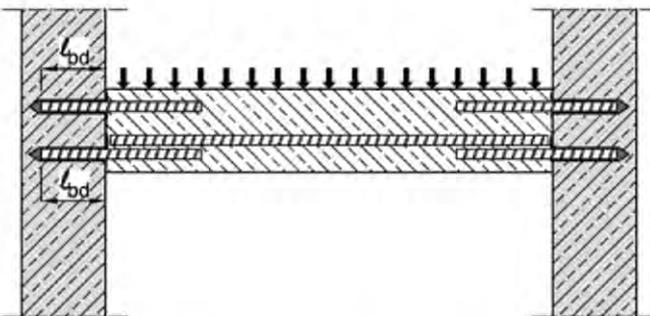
Bewehrungsanschluss überwiegend auf Druck beanspruchter Bauteile. Die Bewehrungsstäbe werden auf Druck beansprucht
